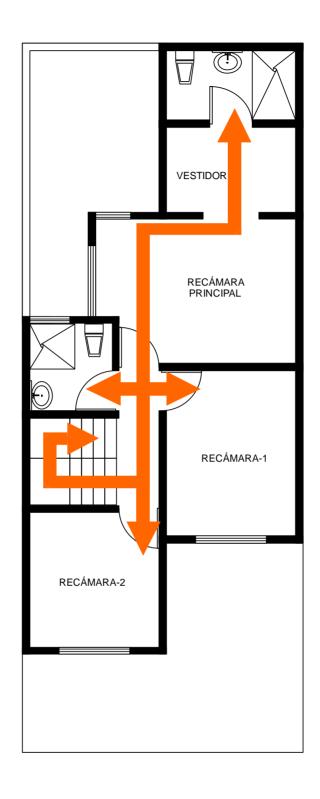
Circulación vertical y horizontal de la planta alta del prototipo de vivienda. Fuente: IGRR, 2008.
